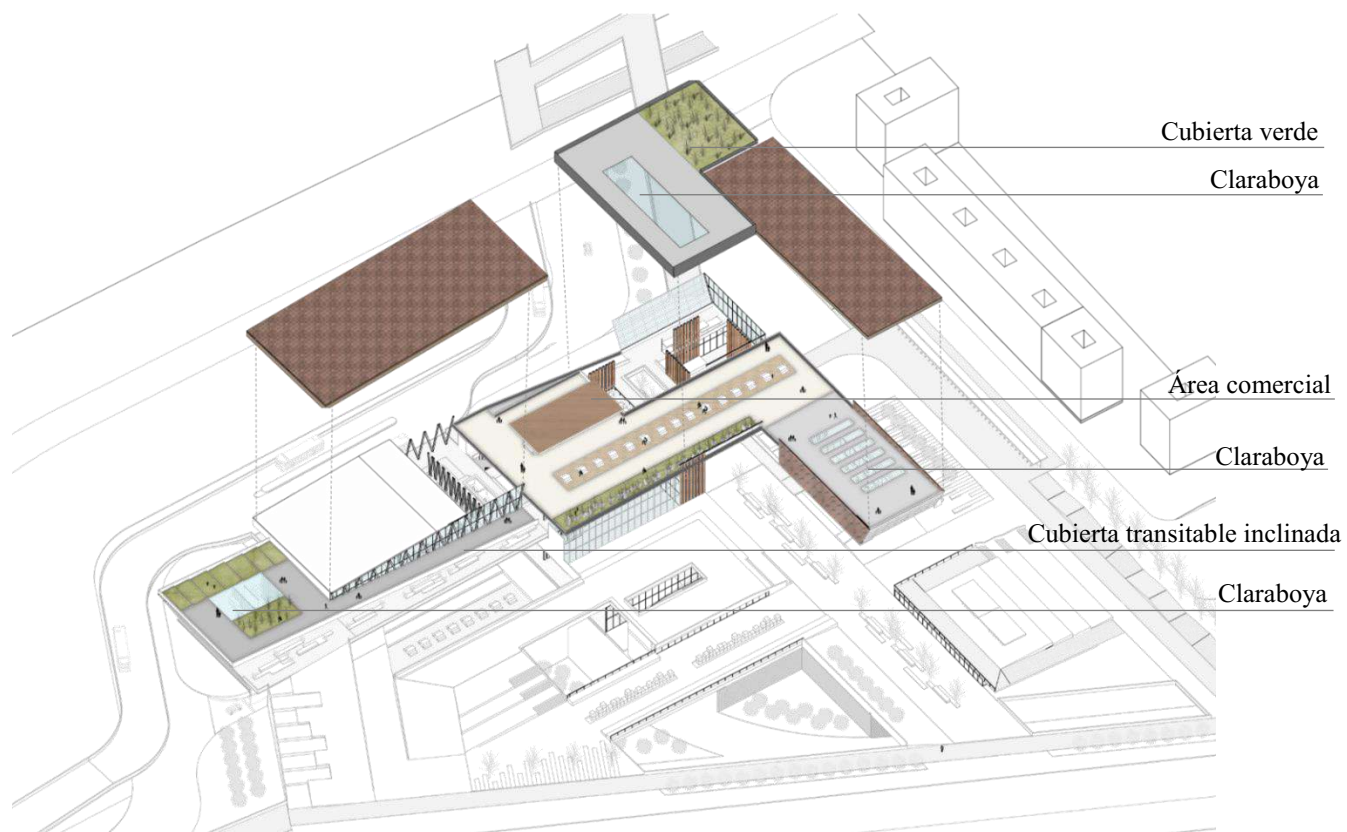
Planta axonometría tercer nivel. Elaboración propia.
